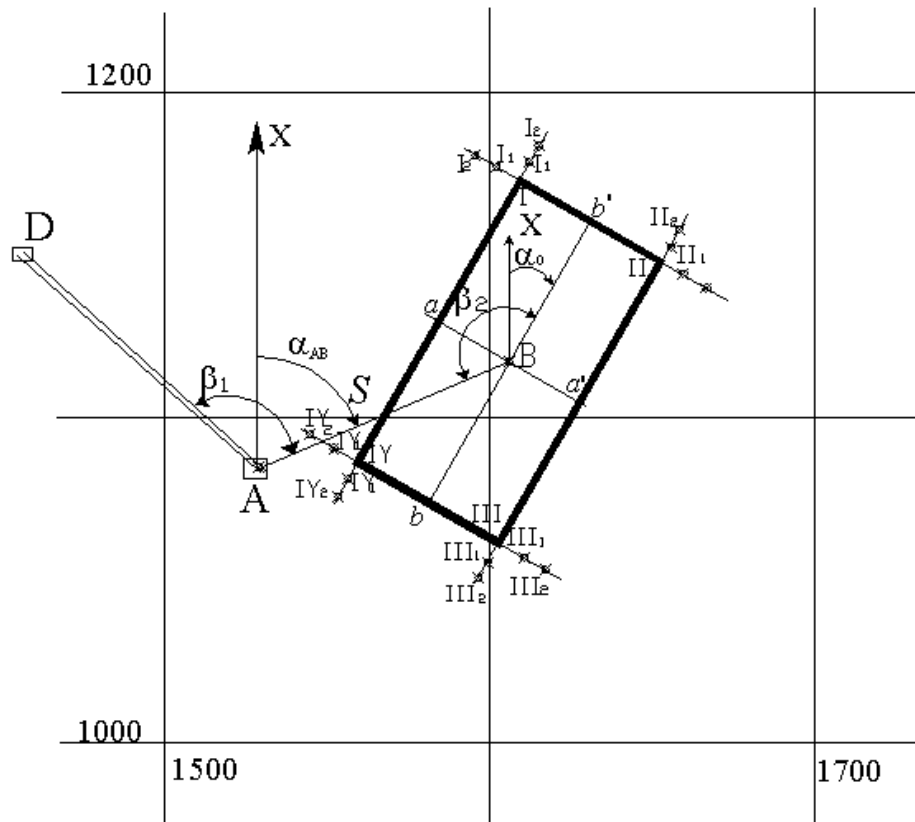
Пояснительная схема к проекту разбивки здания на промышленной площадке карьера.
